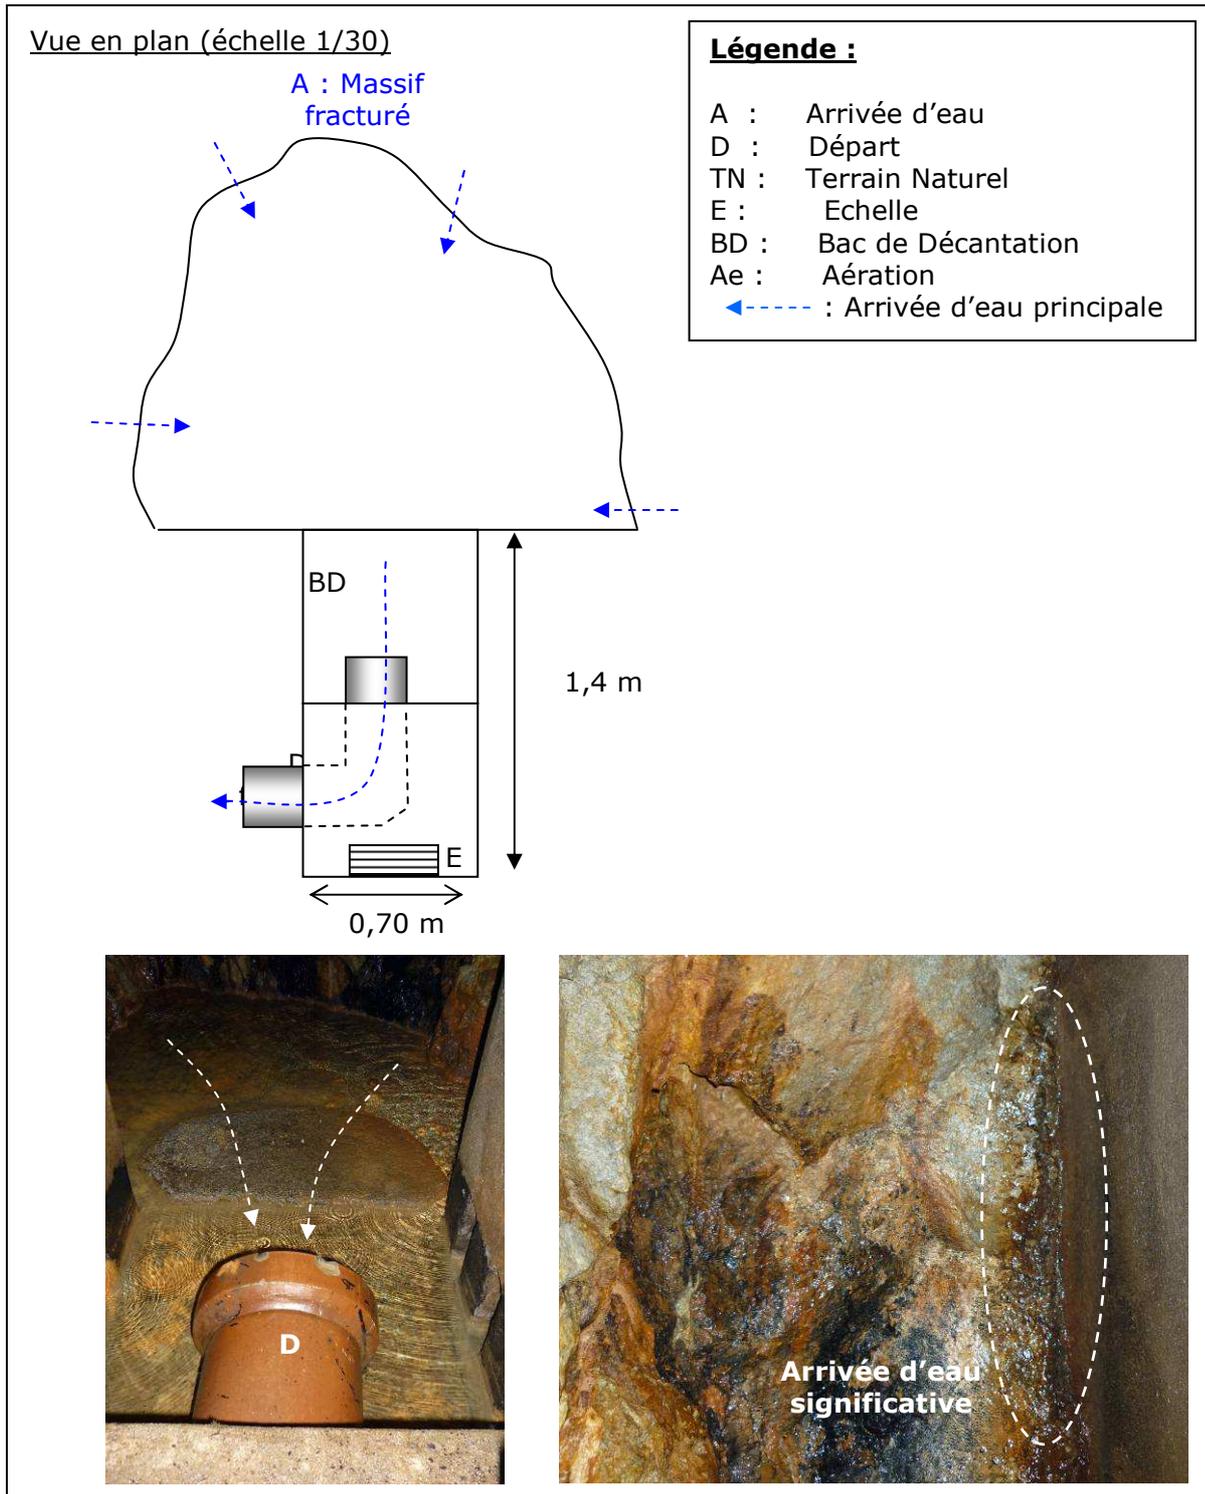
Vue en plan de l'ouvrage de Lempret C1
